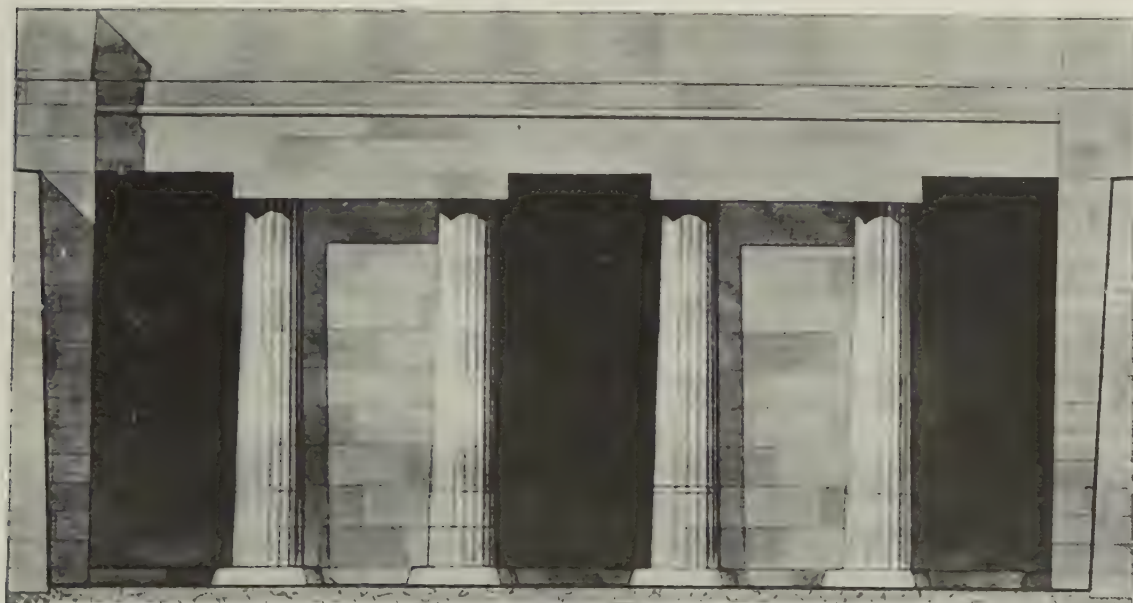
RECONSTITUTION DE LA FAÇADE SUR COUR DU TEMPLE FUNÉRAIRE NORD
